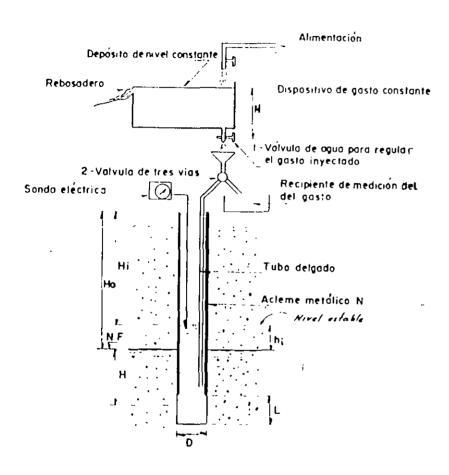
DISPOSICION DEL EQUIPO PARA LA PRUEBA LEFRANC DE INVECCION CON CARGA CONSTANTE
